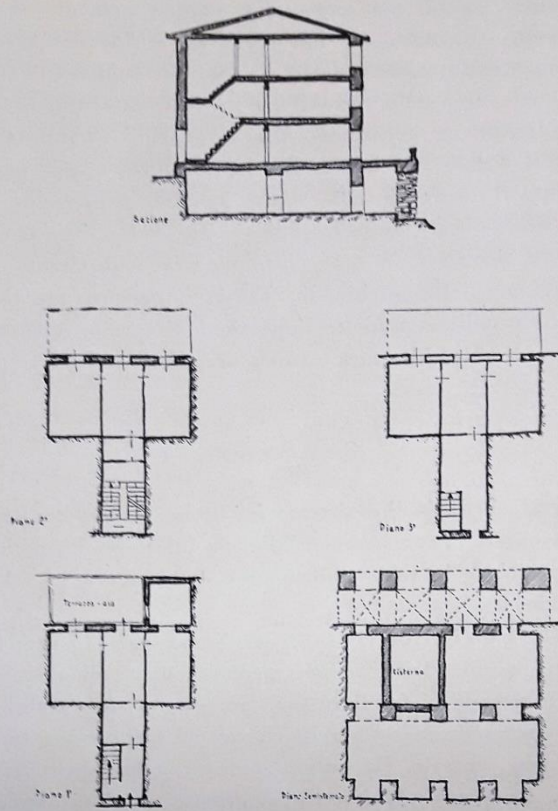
Schema planimetrico di casa rustica con terrazza-aia ubicata in via Roma
